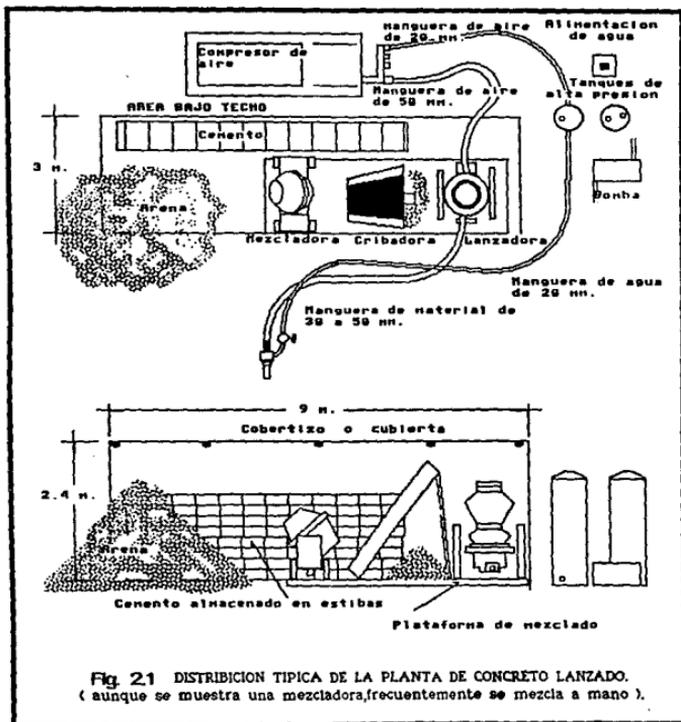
DISTRIBUCION TIPICA DE LA PLANTA DE CONCRETO LANZADO.
